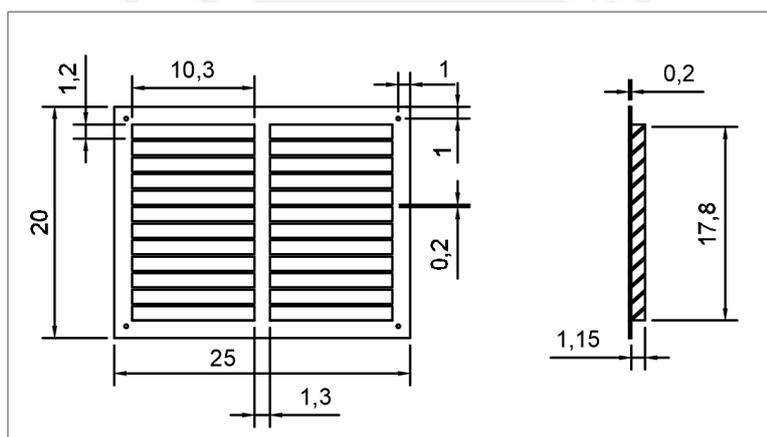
Detalle Referencial de la Rejilla para la Ventilación de los equipos al exterior
